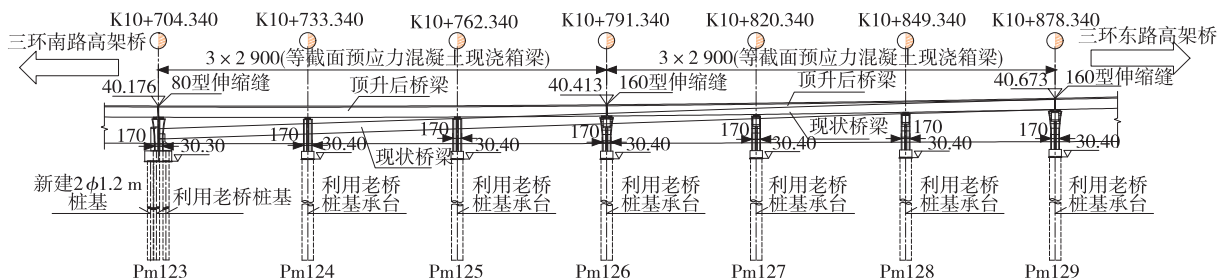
顶升桥梁立面图(单位:标高为 m,其他为 cm)
